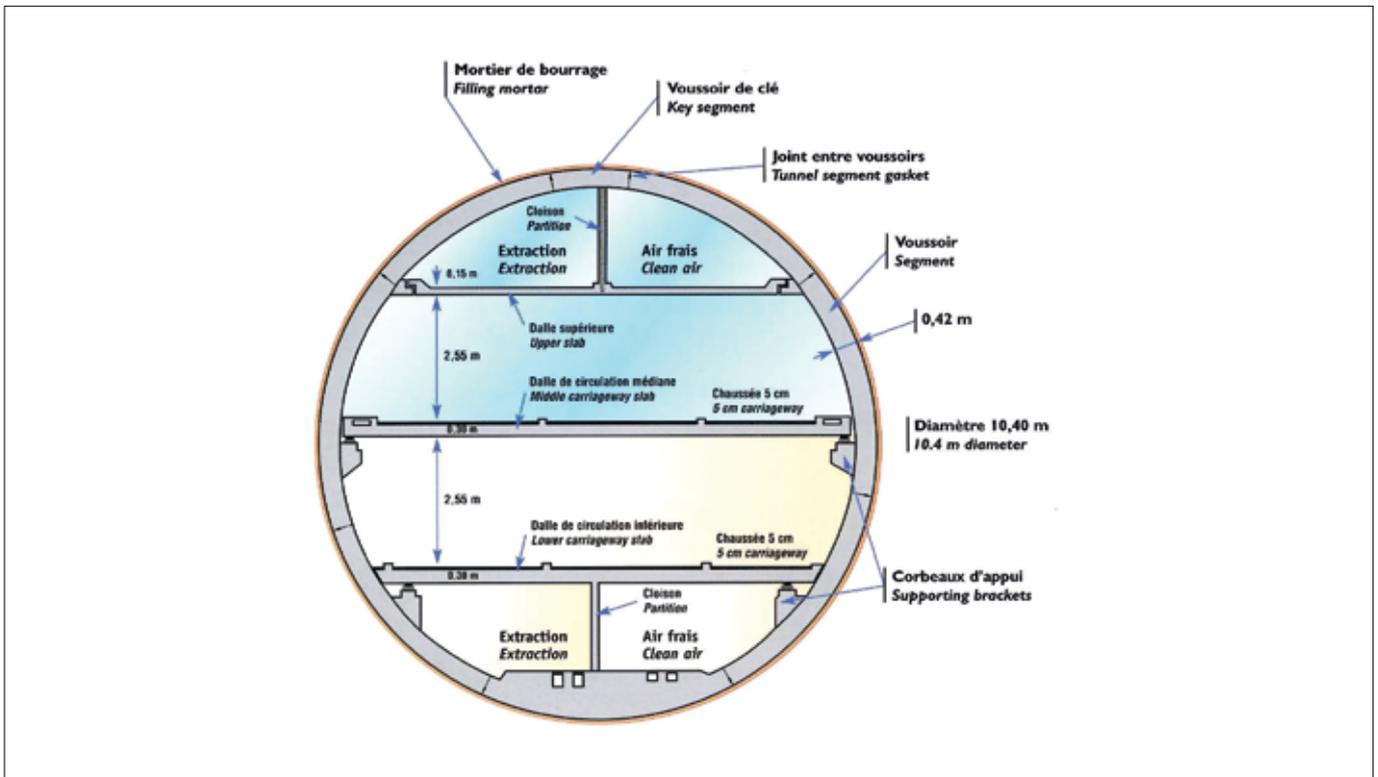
tunnel à chaussées superposées (A86 ouest, 2009-2011)
